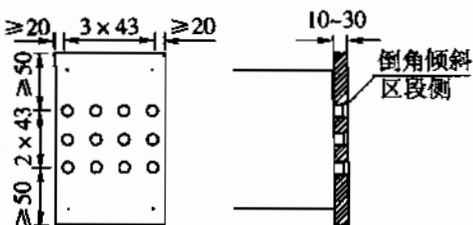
定位钢板构造图(尺寸单位:mm)
